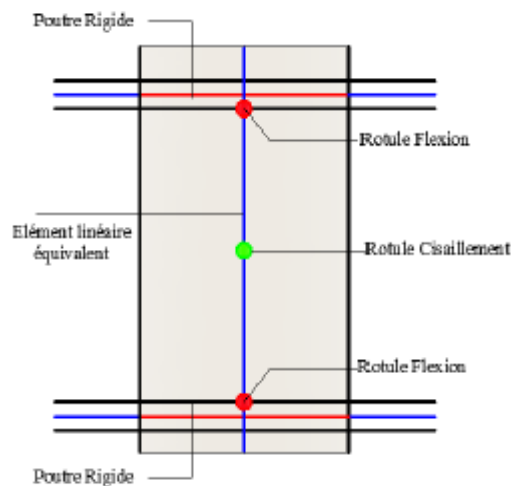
Modélisation du voile par un élément poteau-poutre équivalent.
